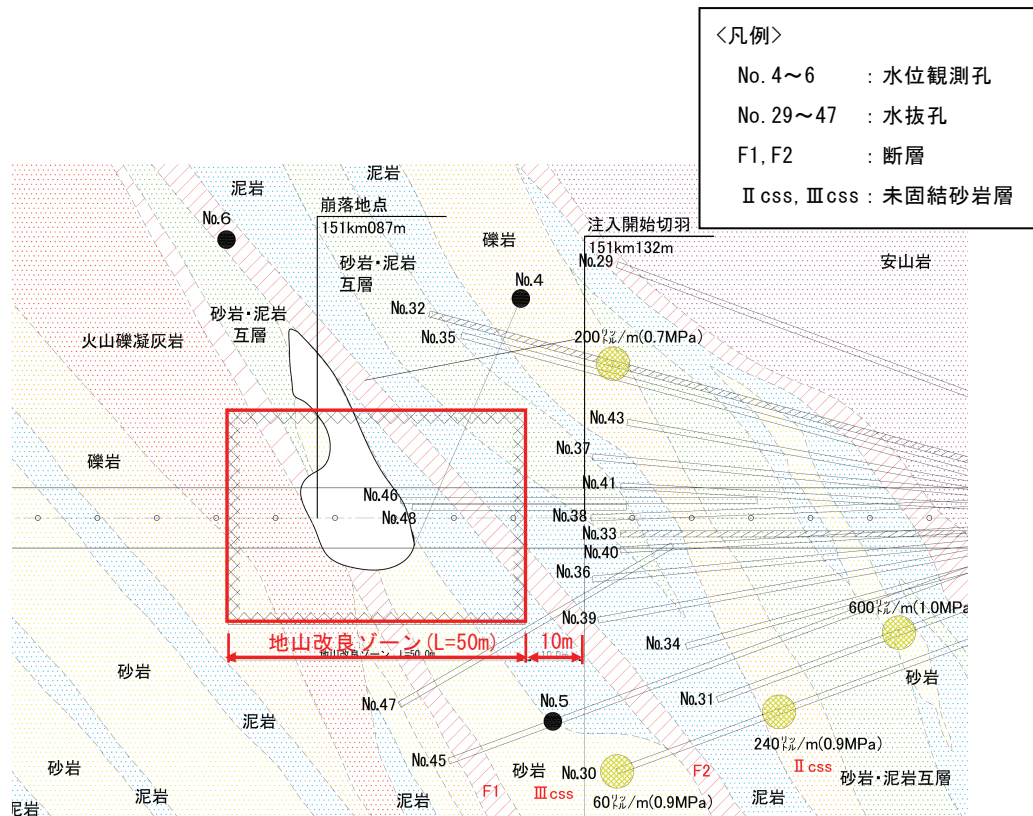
崩落部付近の地質平面図⁹⁾を加筆修正
